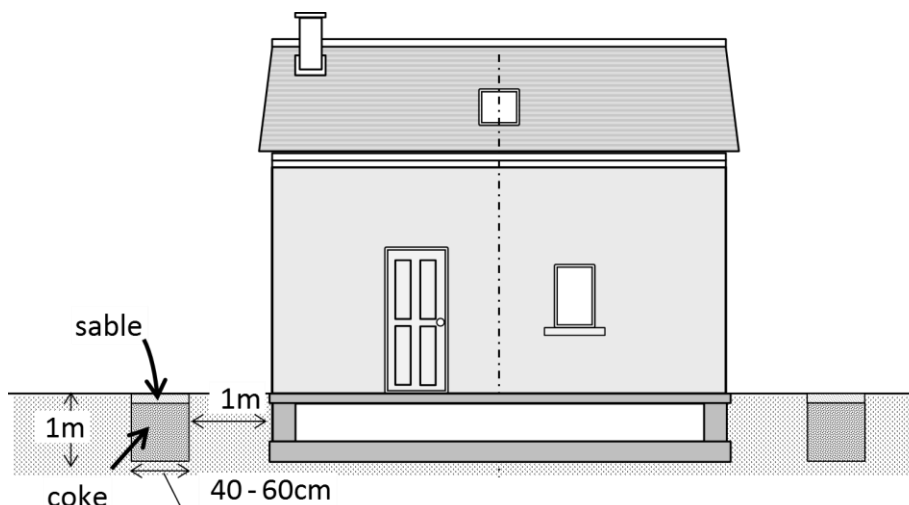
exemple de tranchée compressible périphérique à l'aide de remplissage de type coke
